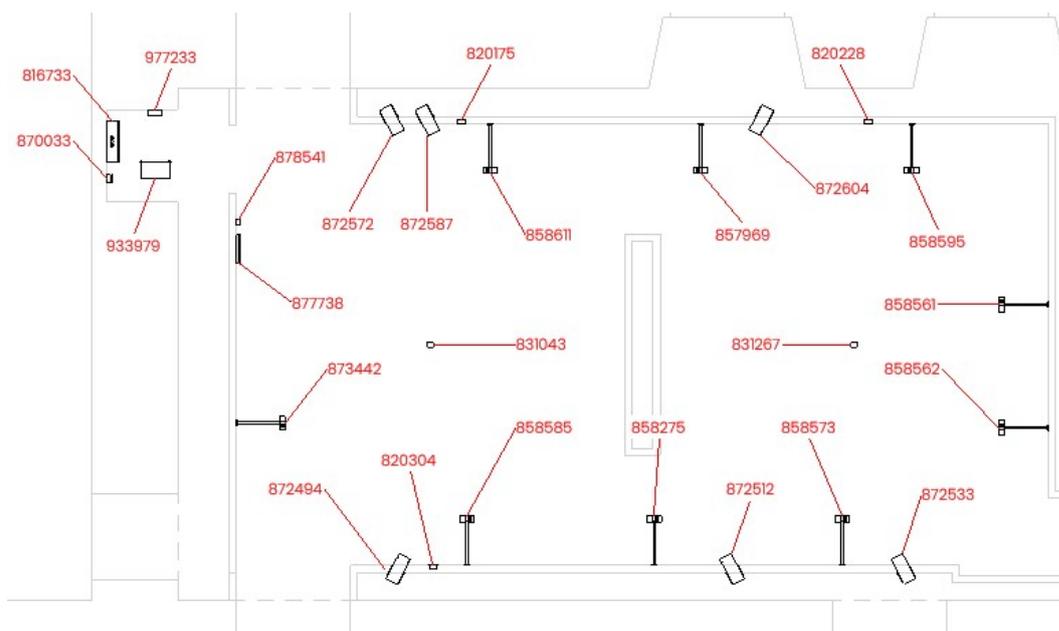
Rappresentazione planimetrica di una porzione della pianta ID.
